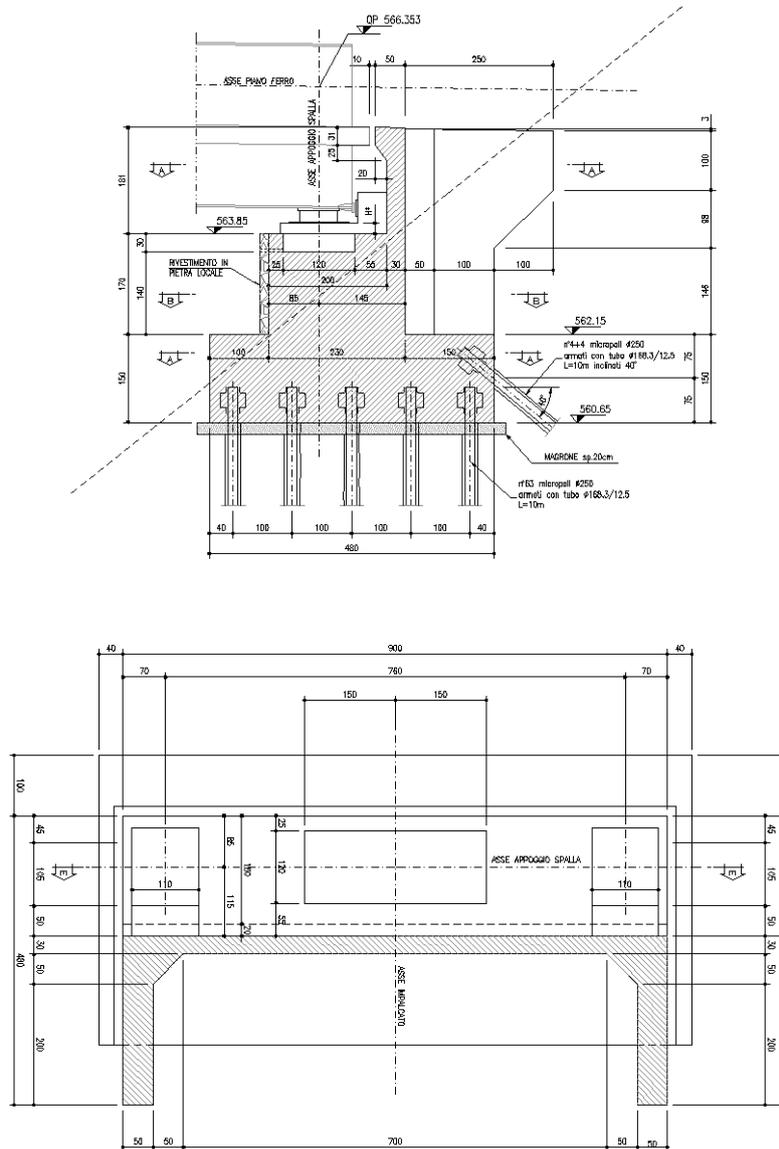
Spalla lato gardena Binario Pari - Sezione trasversale e pianta
